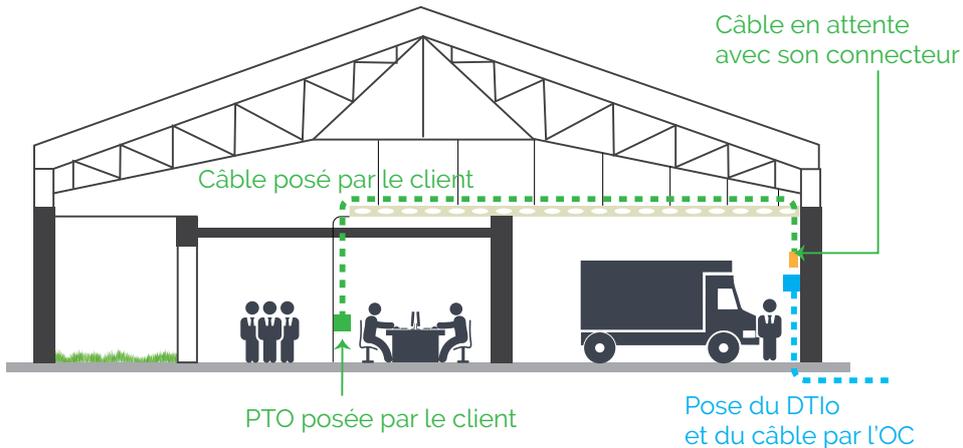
| Reprise du câble client par soudure : cas N°1
